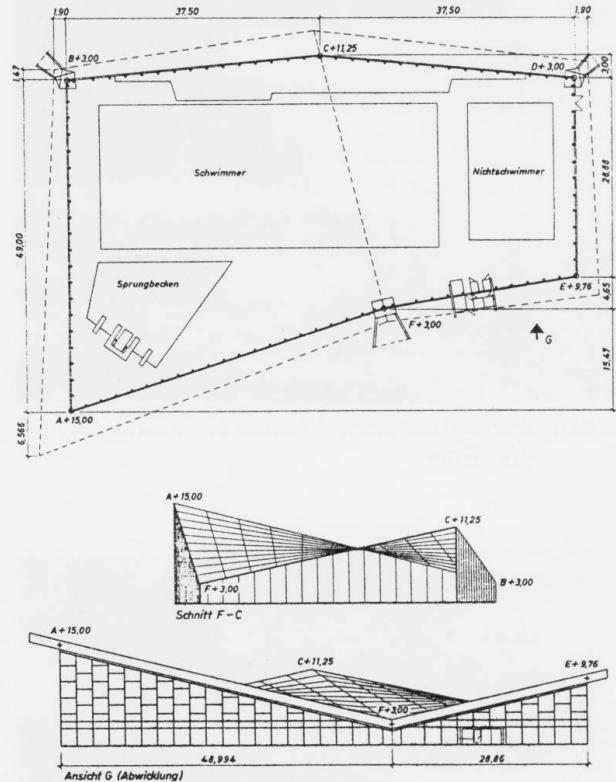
Grundriss, Ansicht und Schnitt der Schwimmhalle
